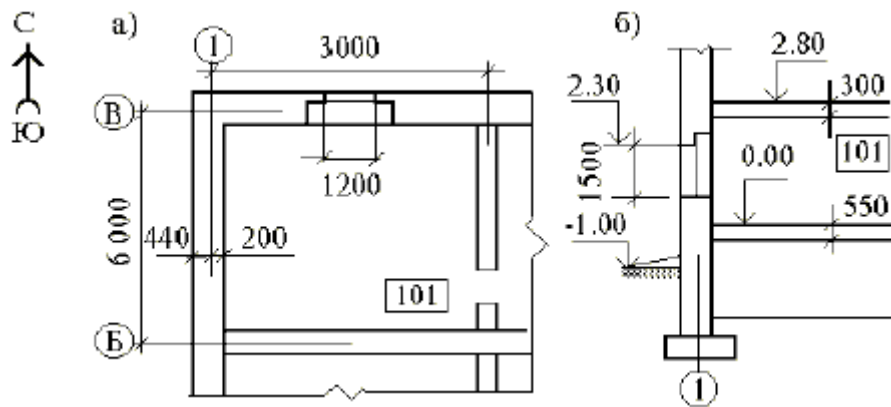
Фрагменты чертежей здания: а – план; б – разрез
